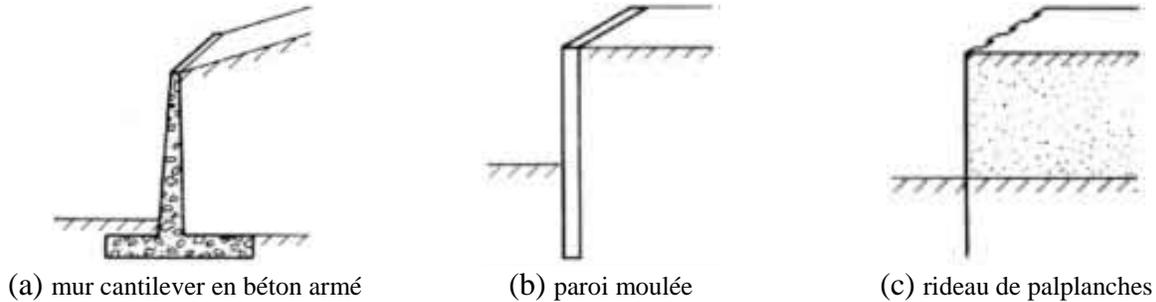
Type d'ouvrages de soutènement - poussée reprise par encastrement
